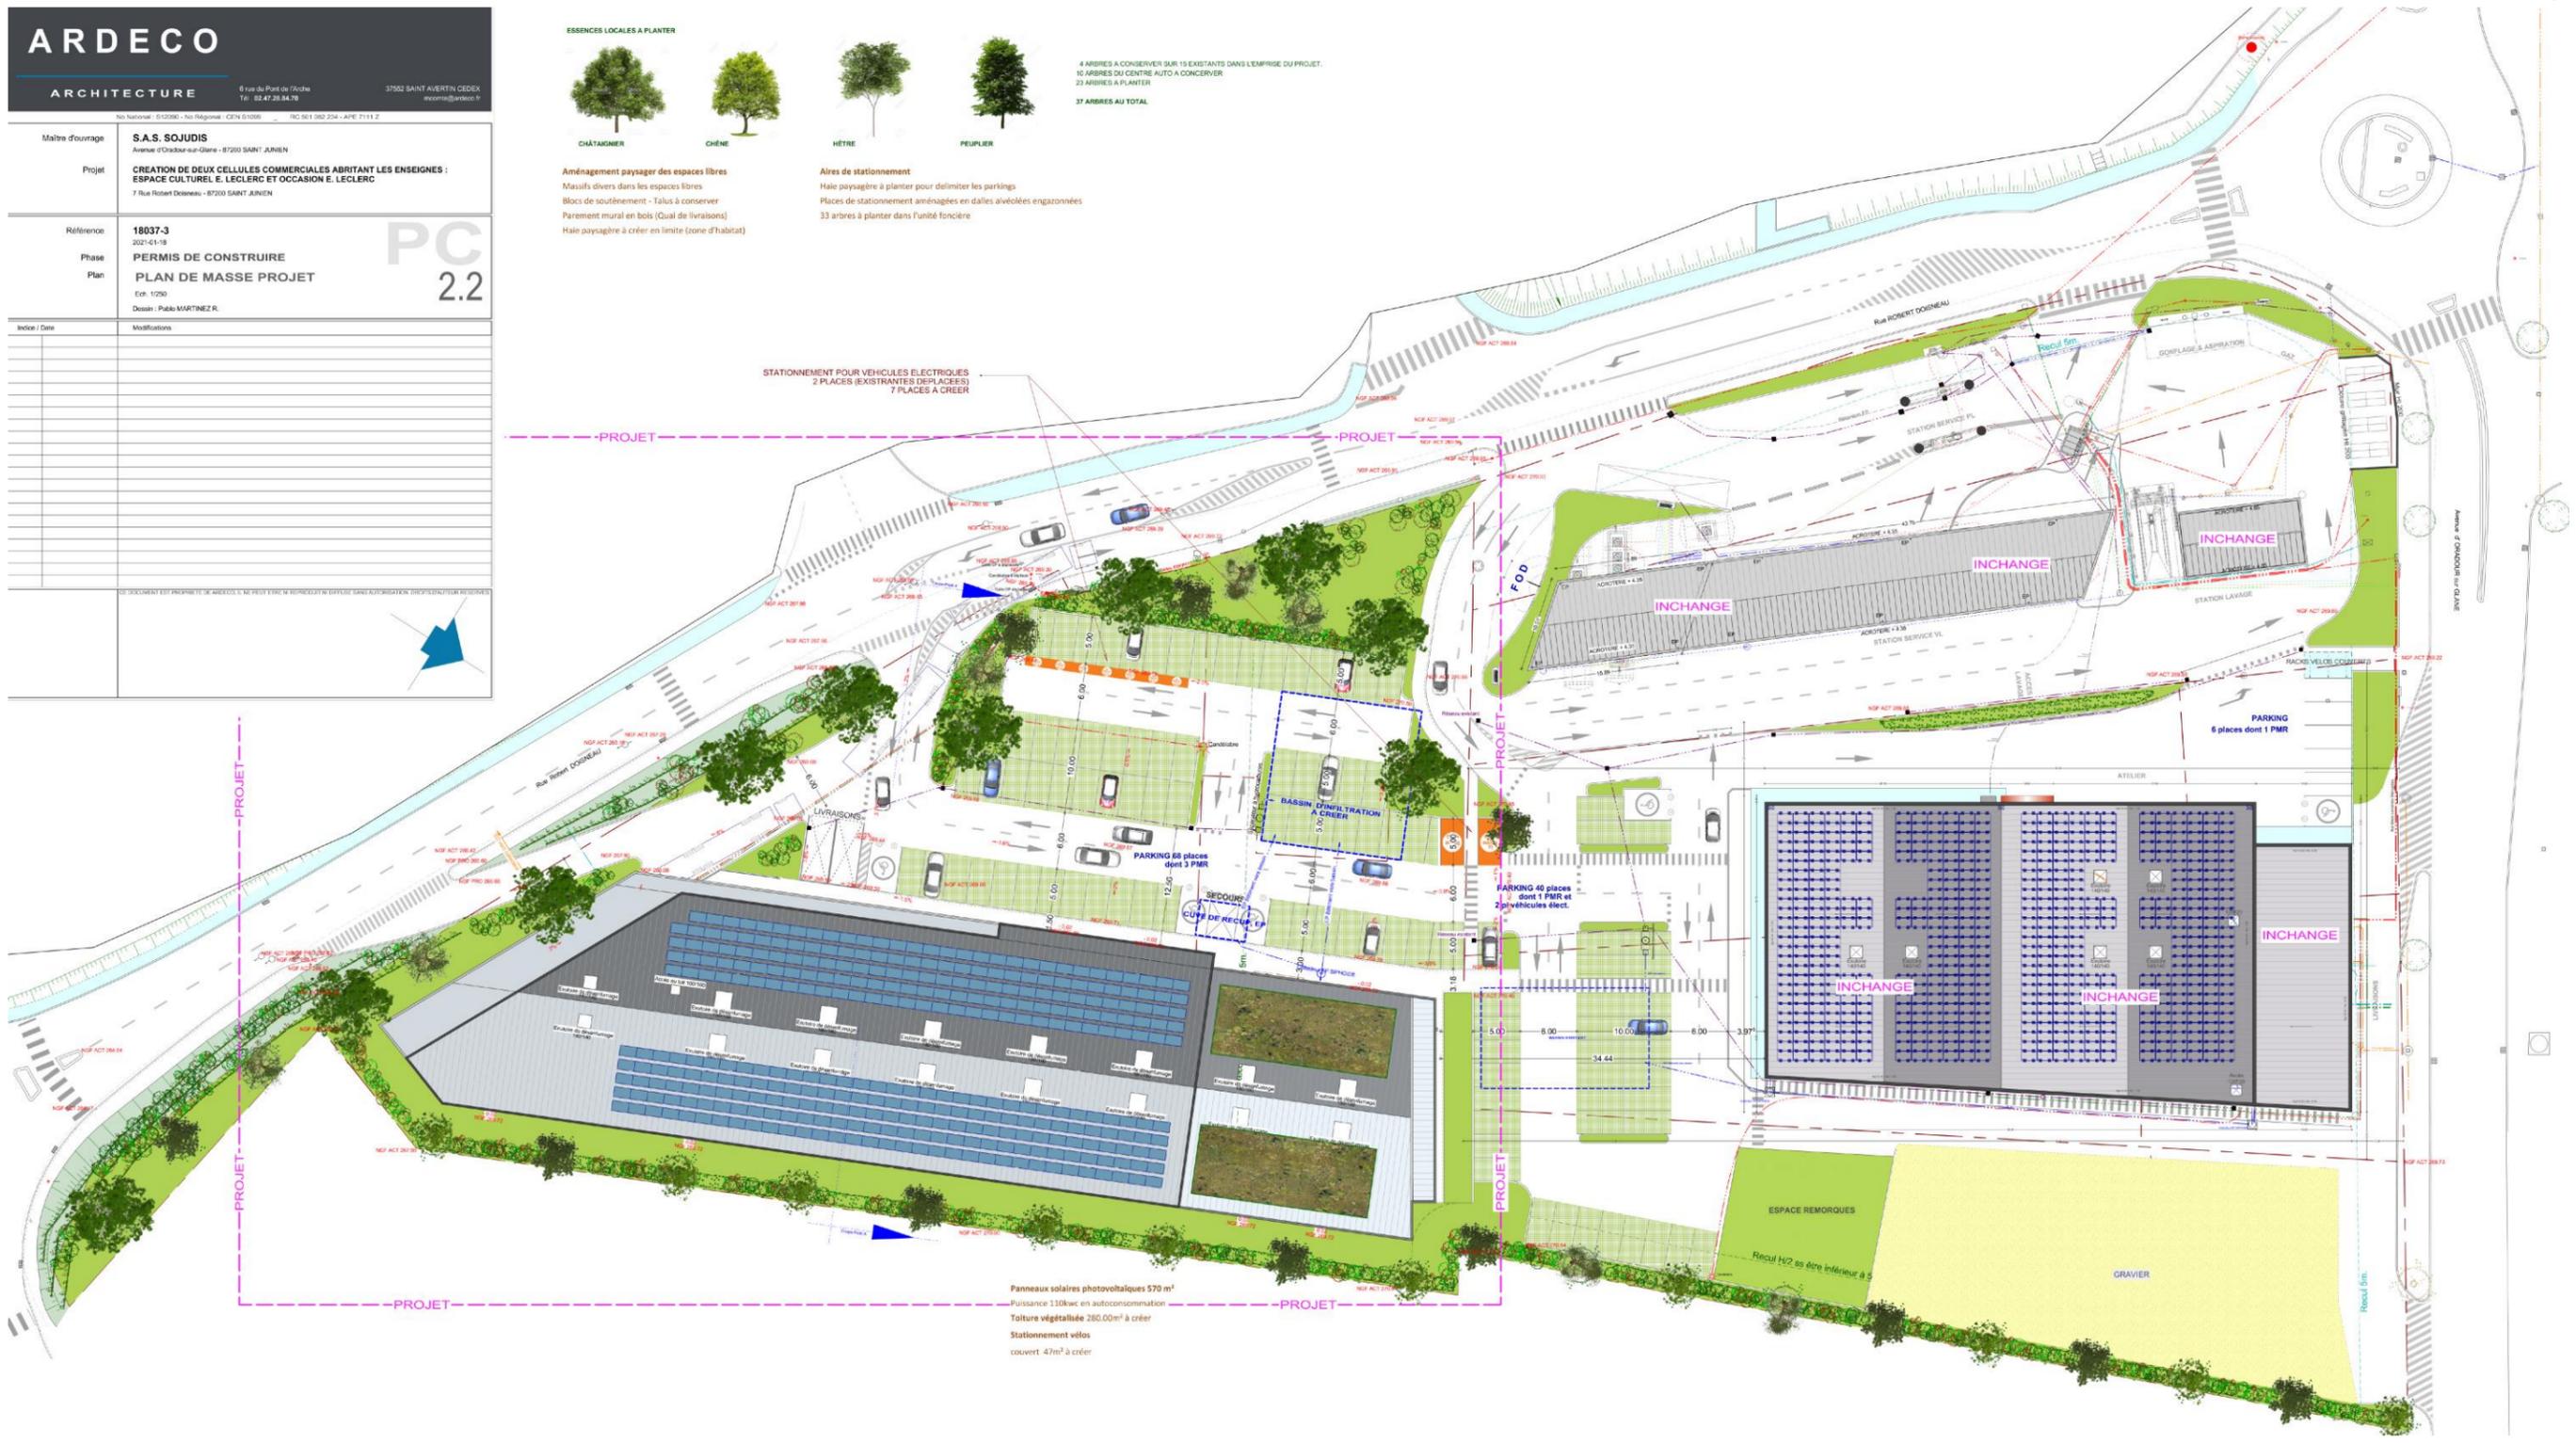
Plan de masse du projet (Source : COMM Archit)
